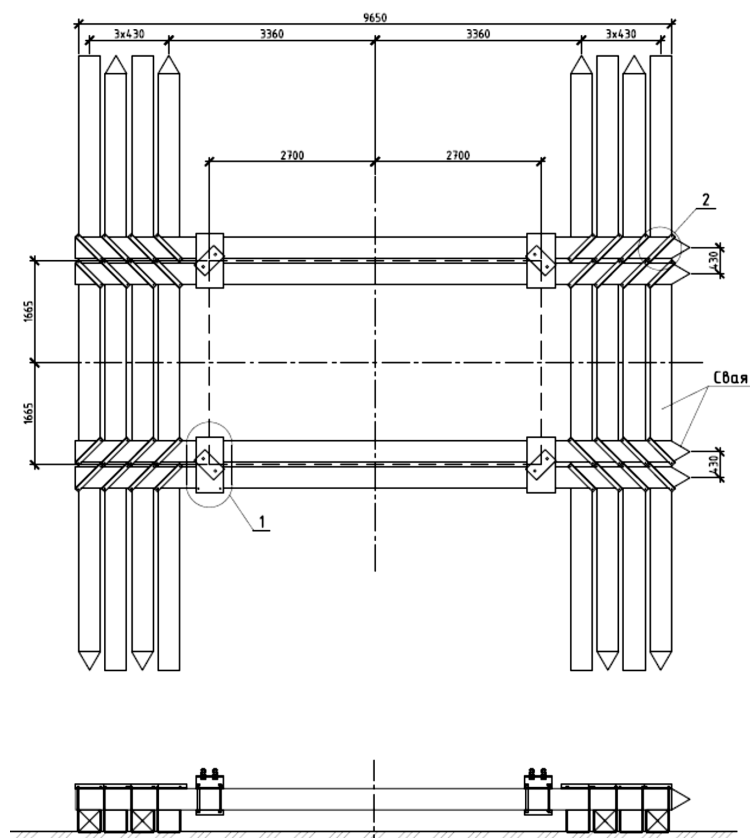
Фундамент ЛФ-220\*10М под опору П220-2
